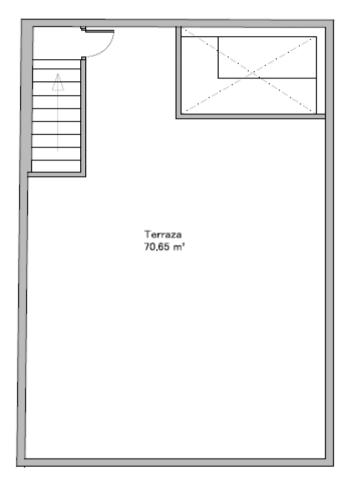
Plano de cubierta de la vivienda años 1940. Fuente: Elaboración propia.
